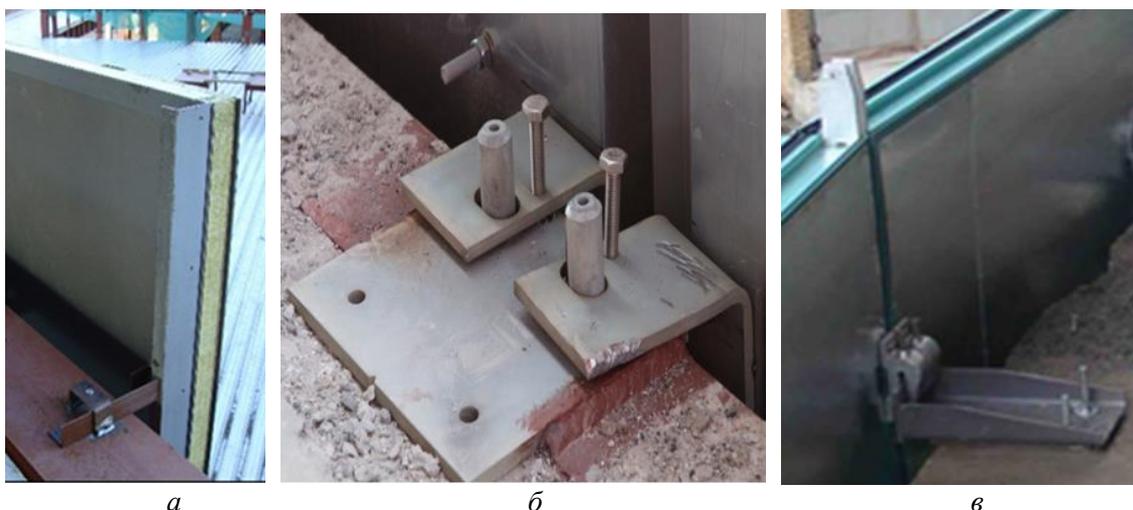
Посадочные кронштейны для монтажа и юстировки фасадных модулей: а – индивидуальные; б, в – парные
